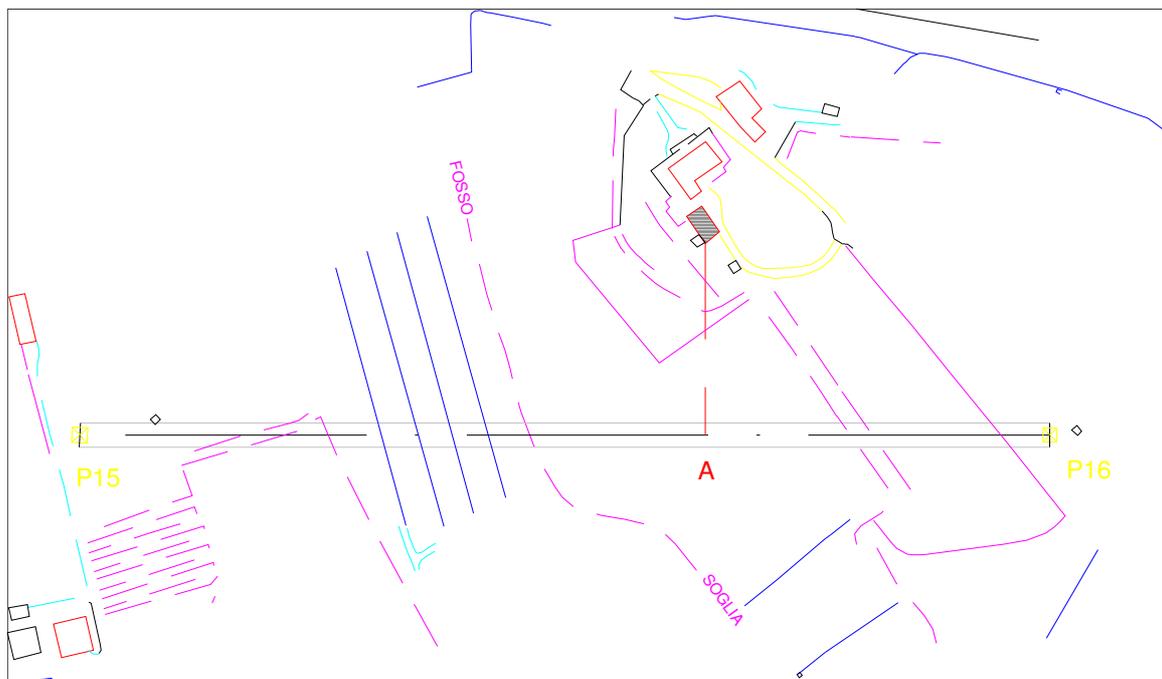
Planimetria di un esempio di situazione espositiva.
